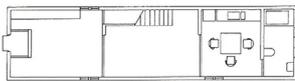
Grundriss Erdgeschoss des Row House (Azuma House) von Tadao Ando in Osaka, 1975.
